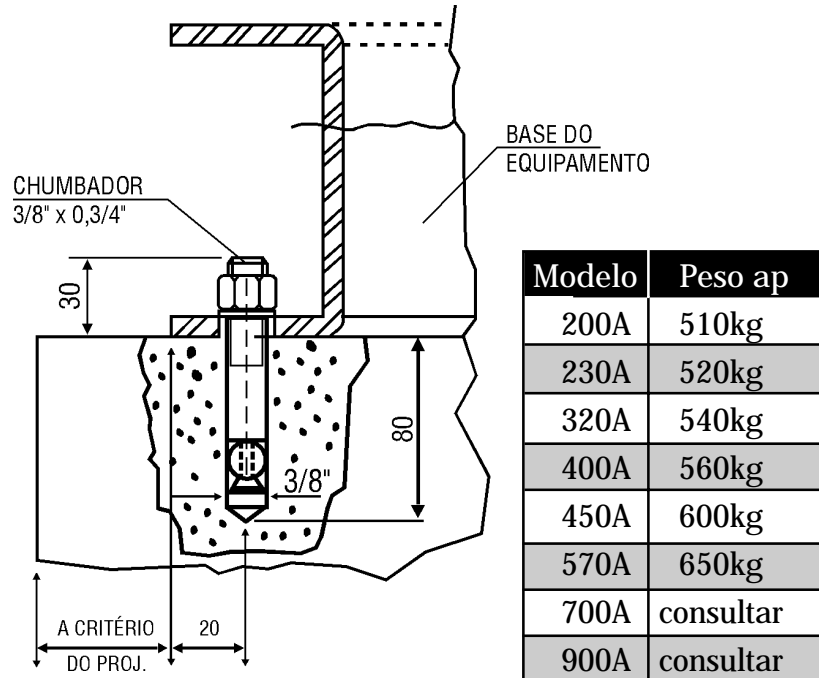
Dimensional/fixação para CFW-05 em painel (AFW-05)
